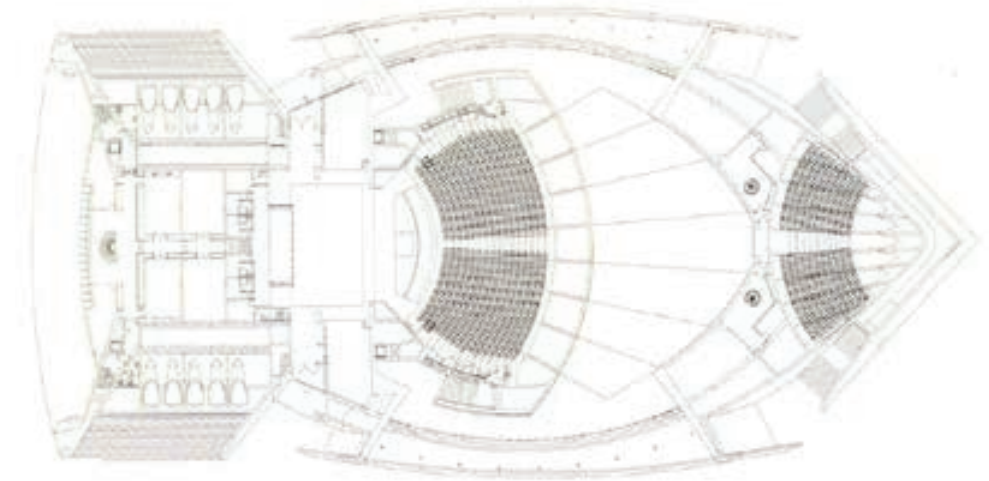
Konzerthaus Santa Cruz Grundriss
